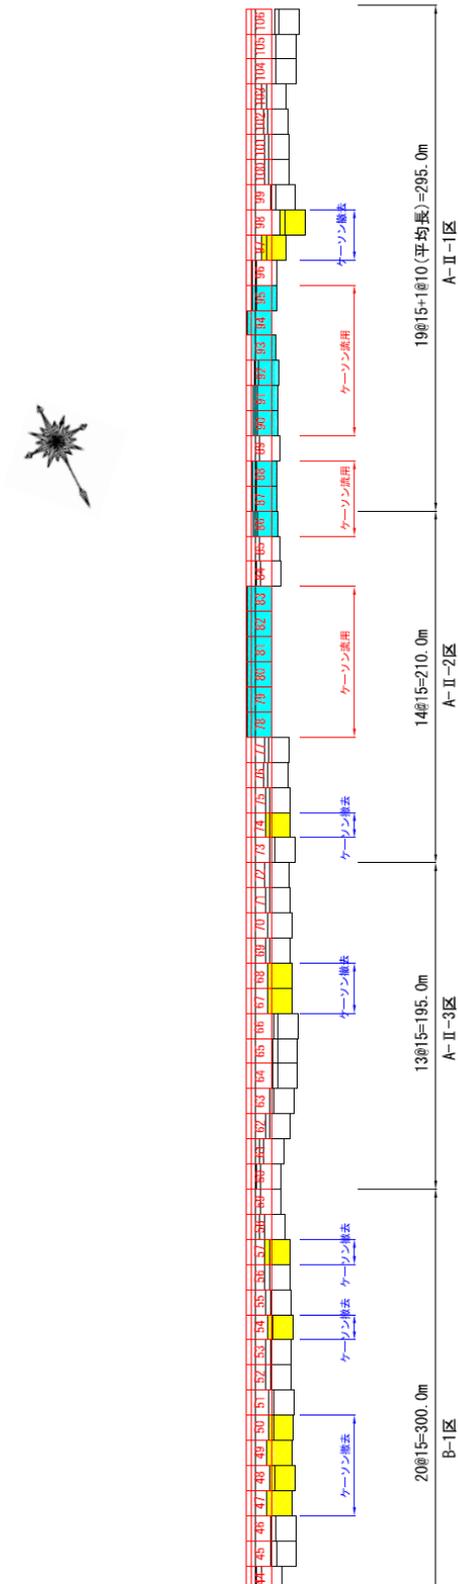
No.1 沖防波堤の断面図 A-II-1 区～B-1 区 (被災後・復旧後)
